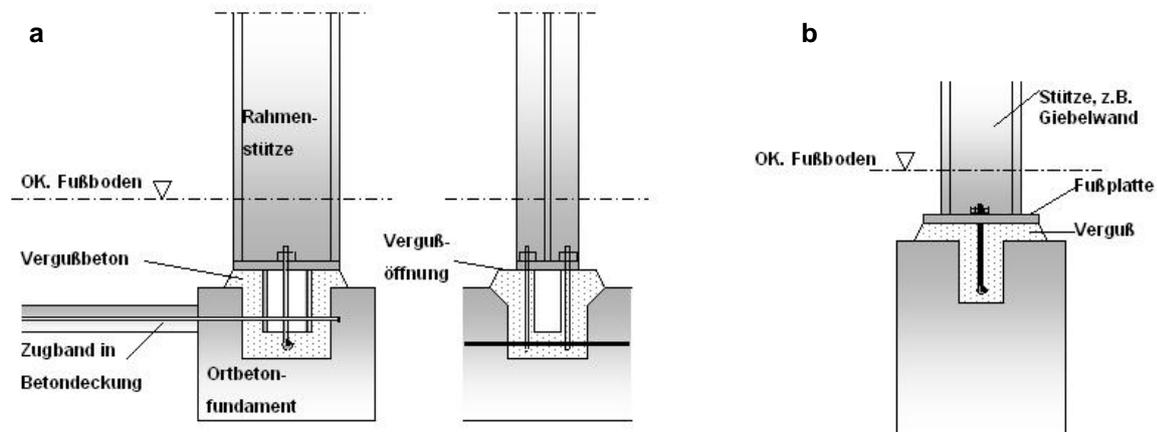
Konstruktive Ausführungsdetails von gelenkigen Stützenanschlüssen
